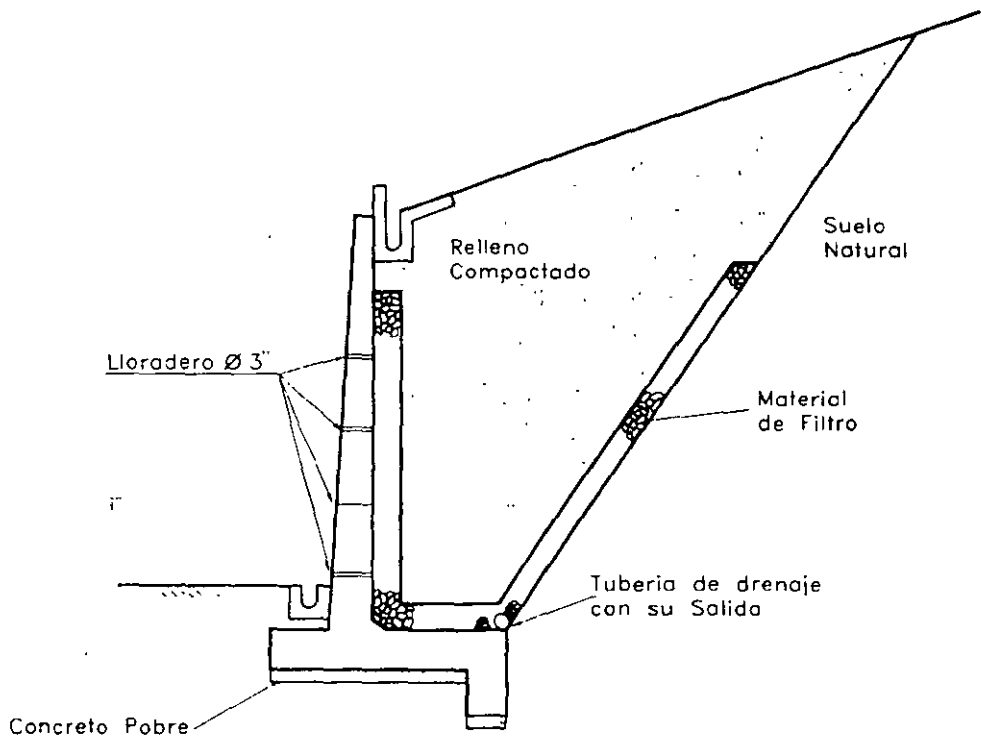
Esquema típico de un muro de concreto armado con su sistema de subdrenaje
